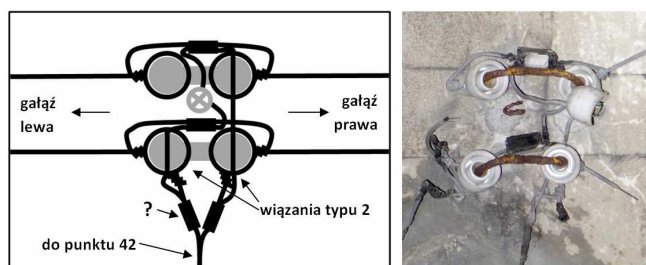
Schemat doprowadzenia zasilania do linii w zewnętrznym pierścieniu (punkty 37 - 41, rysunek bez zachowania skali)
